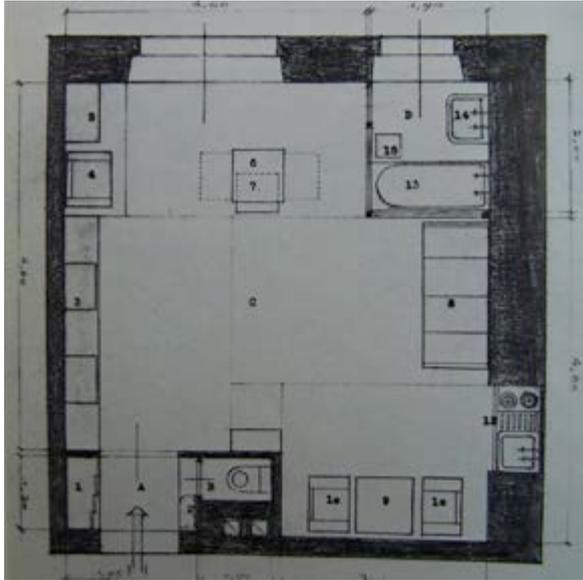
Ateliergemeinschaft, Grundriss der Wohnung Dr. Heller, um 1927/28.
